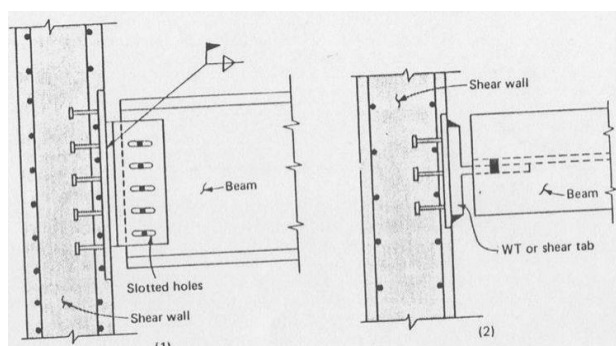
détail d'assemblage d'une poutre métallique et un voile[23].
